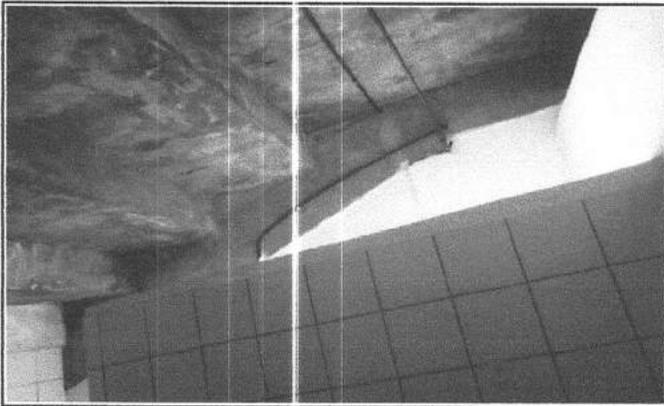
REVESTIMENTO FUNDO DE LAJE E ARQUIBANCADA
